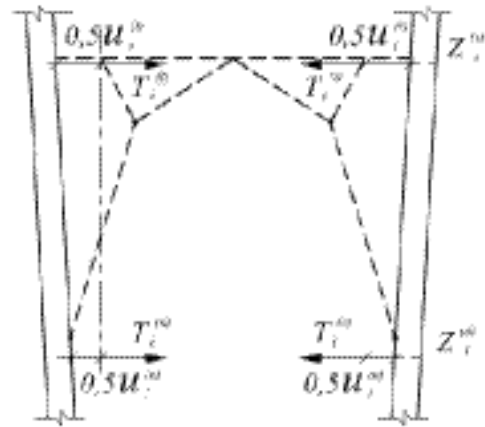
Схема усилий в узлах решетки от горизонтальных перемещений колонн
